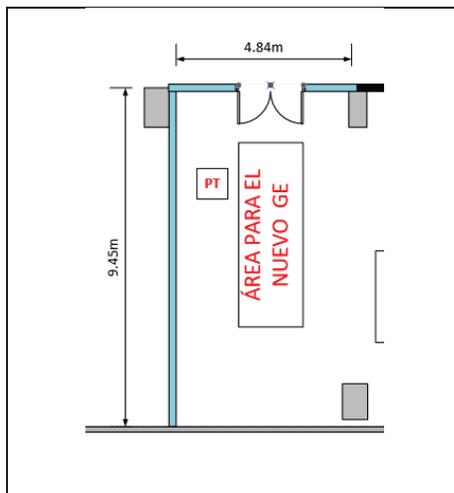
Dimensiones de la malla para instalar en Sede Washington
